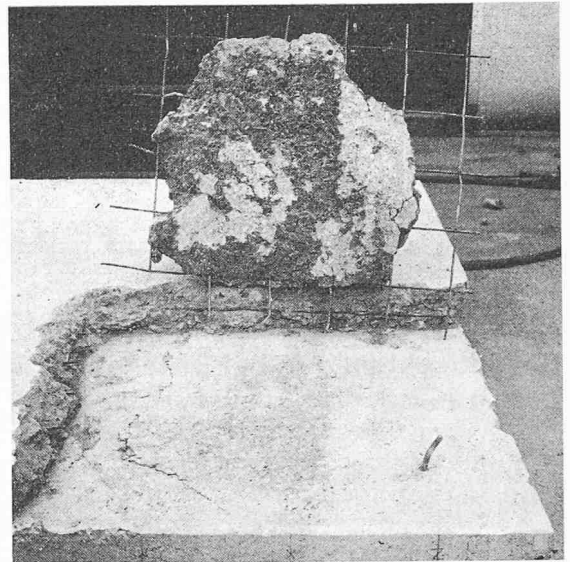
Weggetrennte und abgehobene Eckpartie des Deckbelages nach dem statischen Bruchversuch von Platte 1. Bemerkenswert: Mörtelhaft und sogar Betonteile von UK-Deckbelag zum Teil auf OK-Konstruktionsbeton haften geblieben (dunkle Partien)
